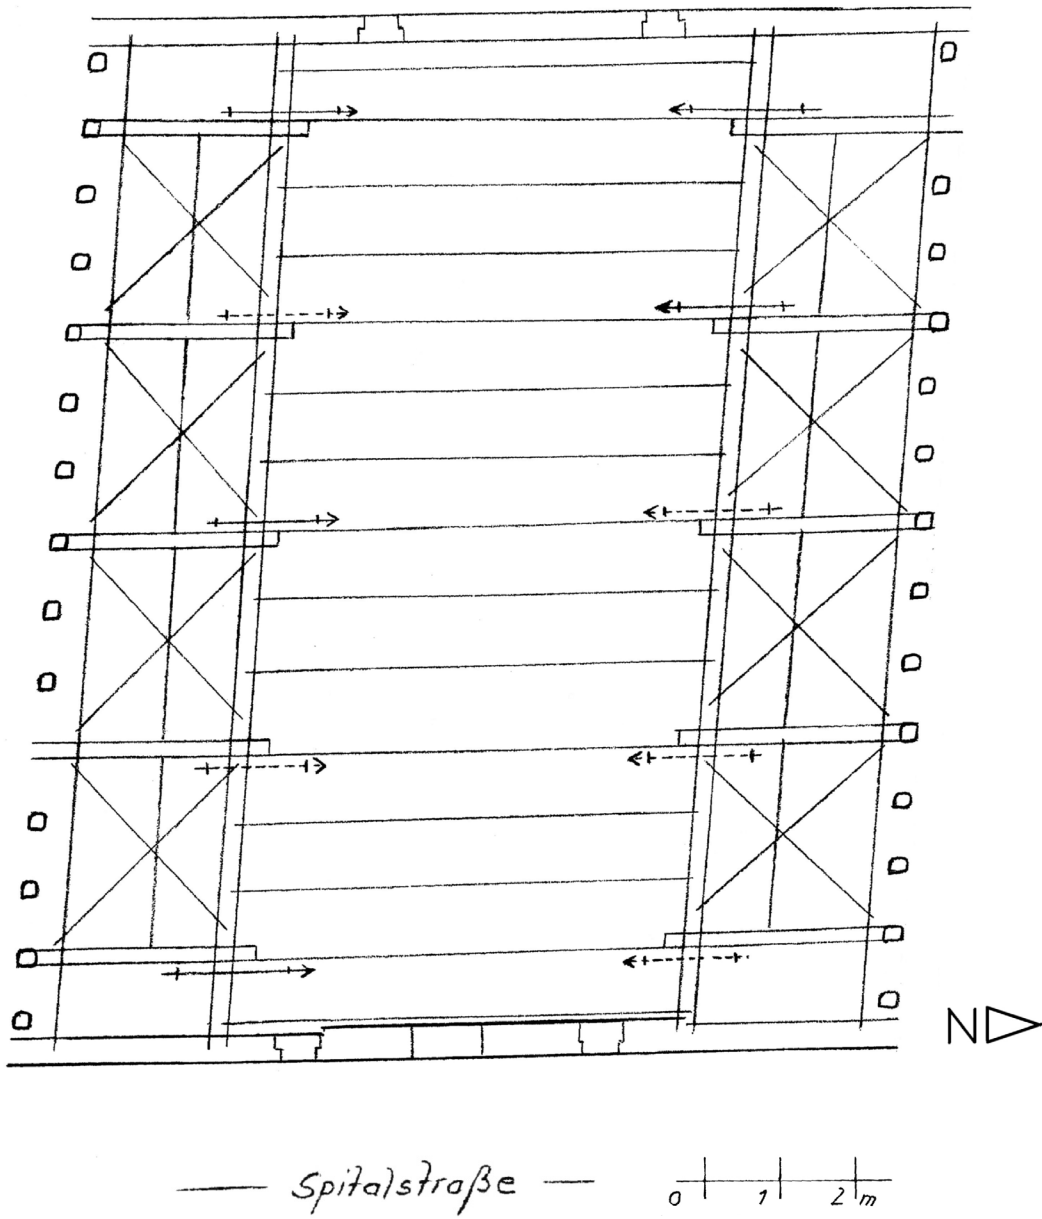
Spitalstraße 33, Grundriss 2. Dachgeschoss, 1580 (d).
